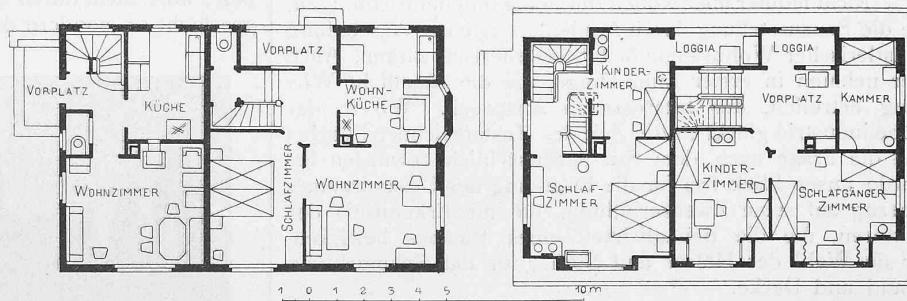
Grundrisse zu Erdgeschoss und Dachstock des Zweifamilienwohnhauses (Abb. 4). — 1:250.
